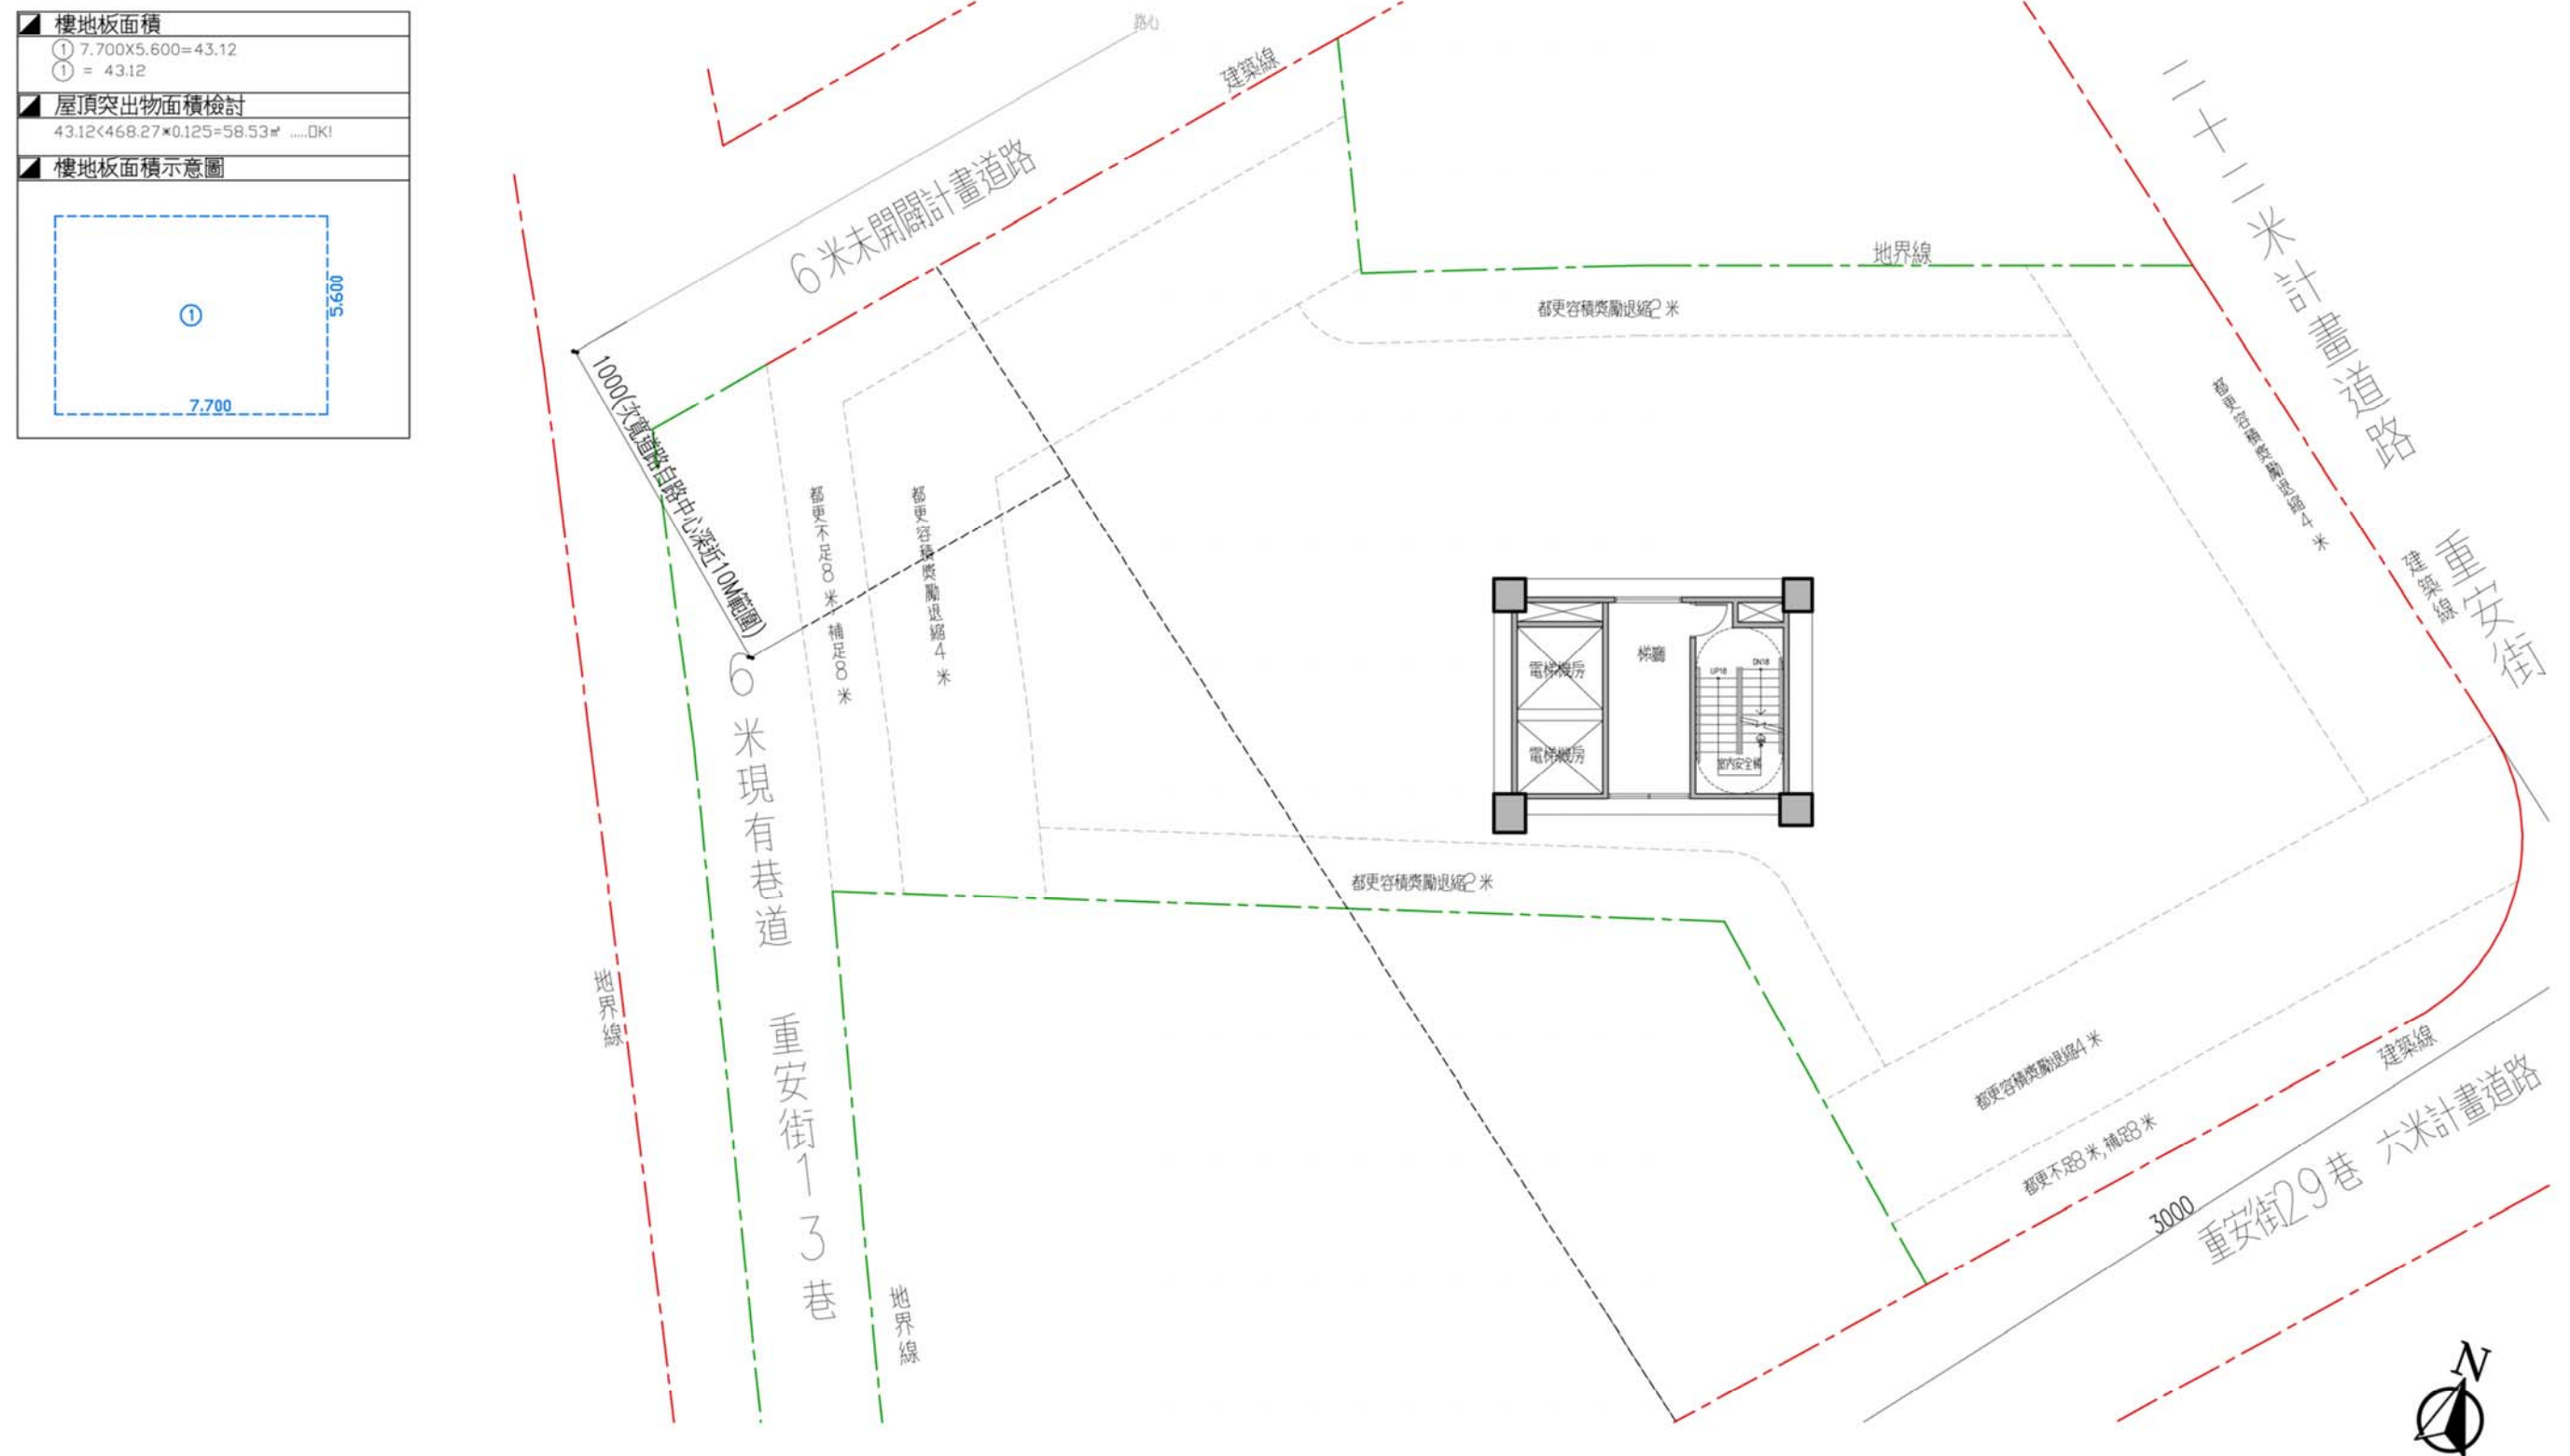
屋突二層平面及面積計算圖(S=1/200)
